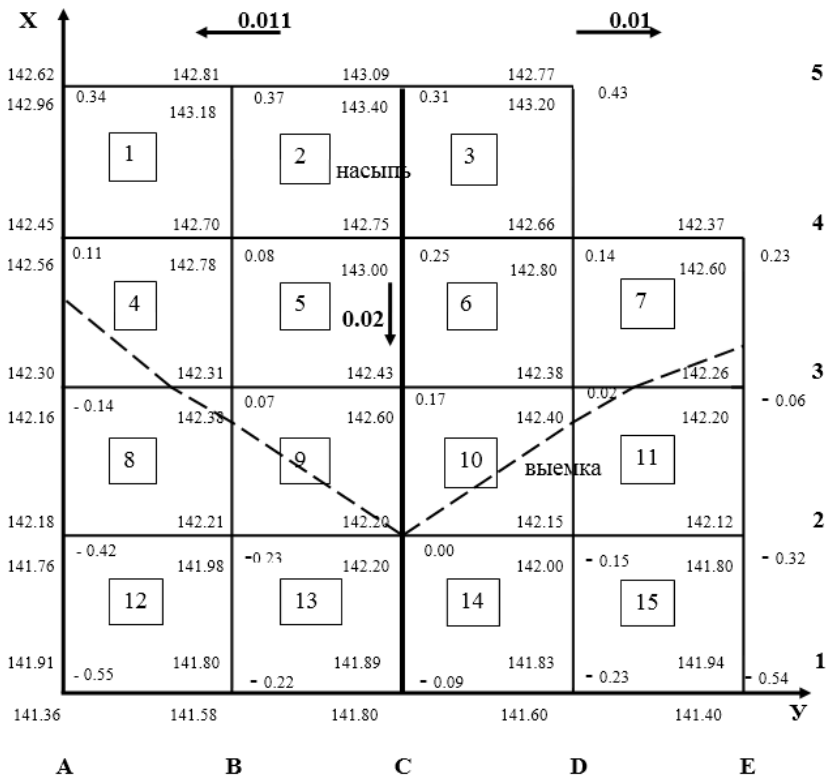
Картограмма земляных работ (двухскатная поверхность)
